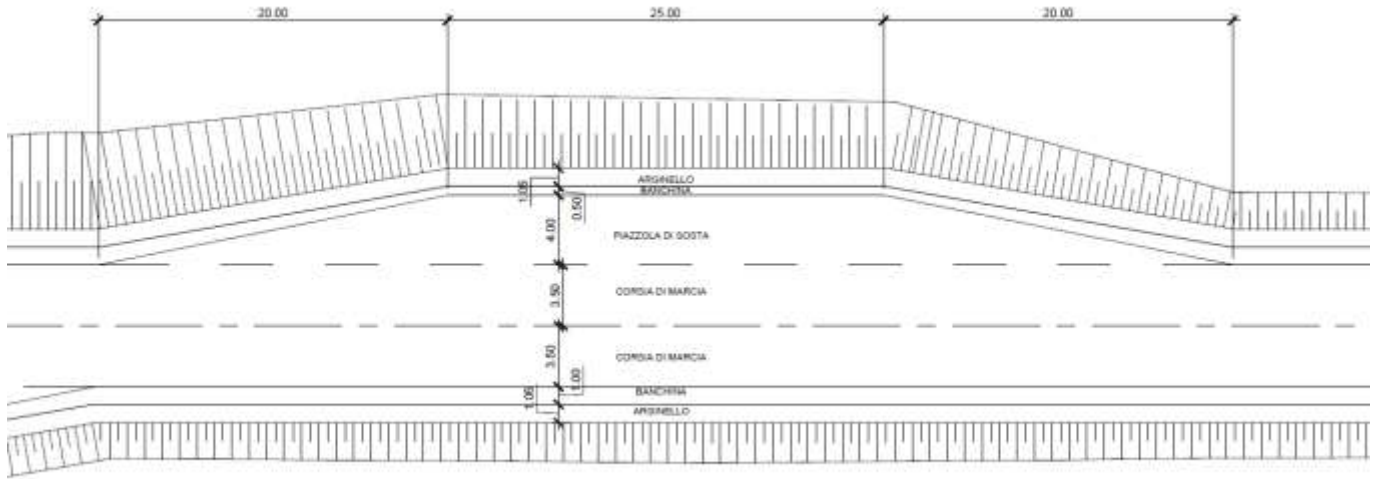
2 SCHEMA PLANIMETRICO DELLA PIAZZOLA DI SOSTA
